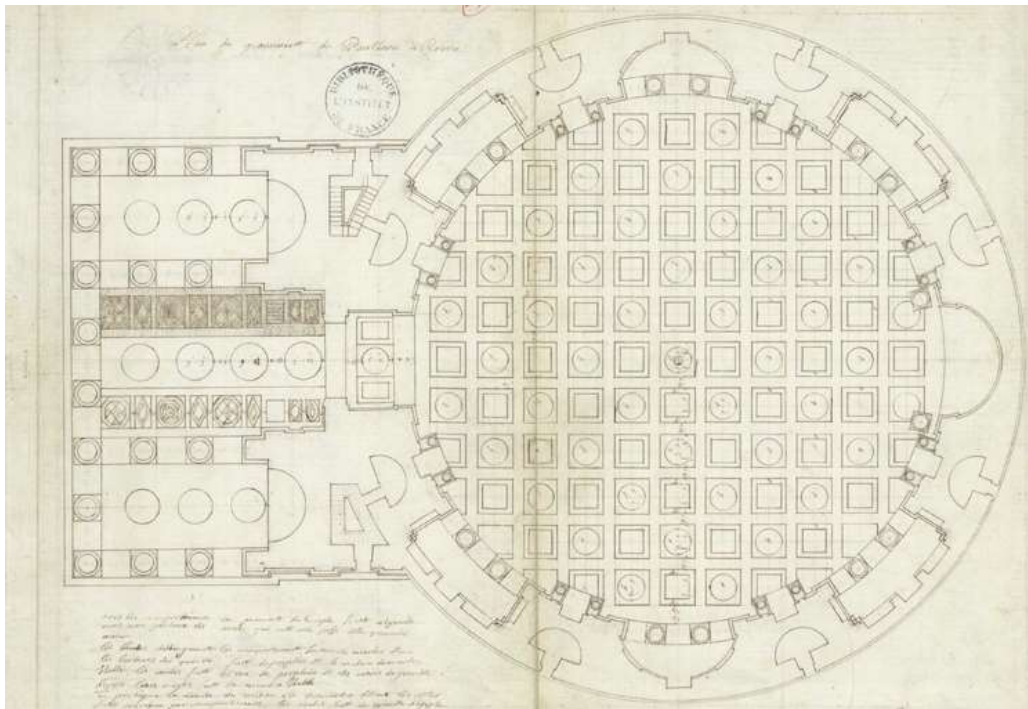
Pianta delle pavimentazioni, primo manoscritto - Desgodets 1676 - 1677
